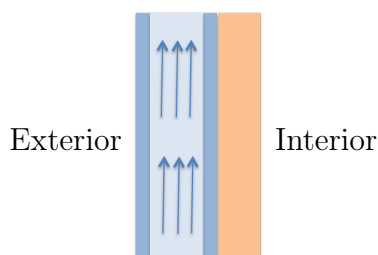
Esquema de fachada compuesta por: Elemento exterior ligero, elemento interior masivo con aislante hacia la cámara.
